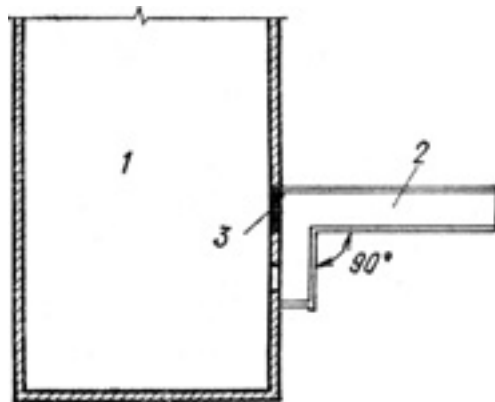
Вход с поворотом на 90°: 1- укрытие; 2 – вход; 3 – участок стены, толщина которого определяется расчетом
